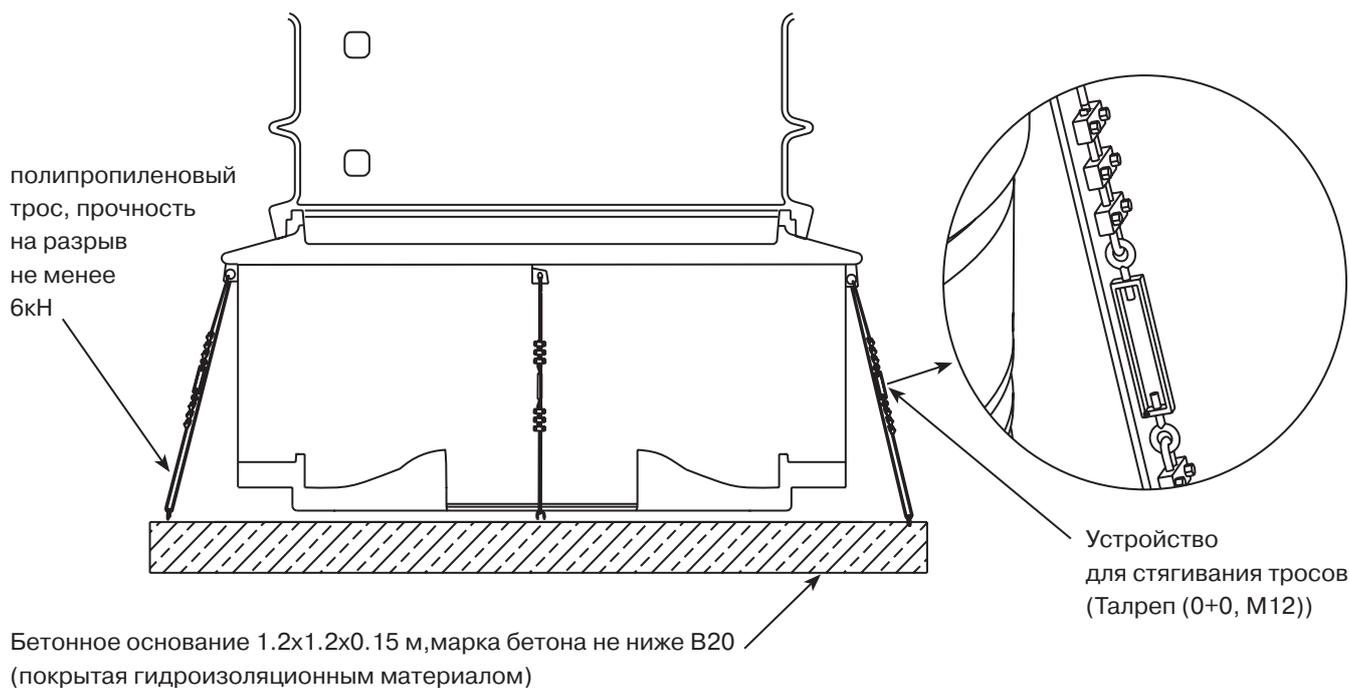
Пригружение анкерением к железобетонной плите.
